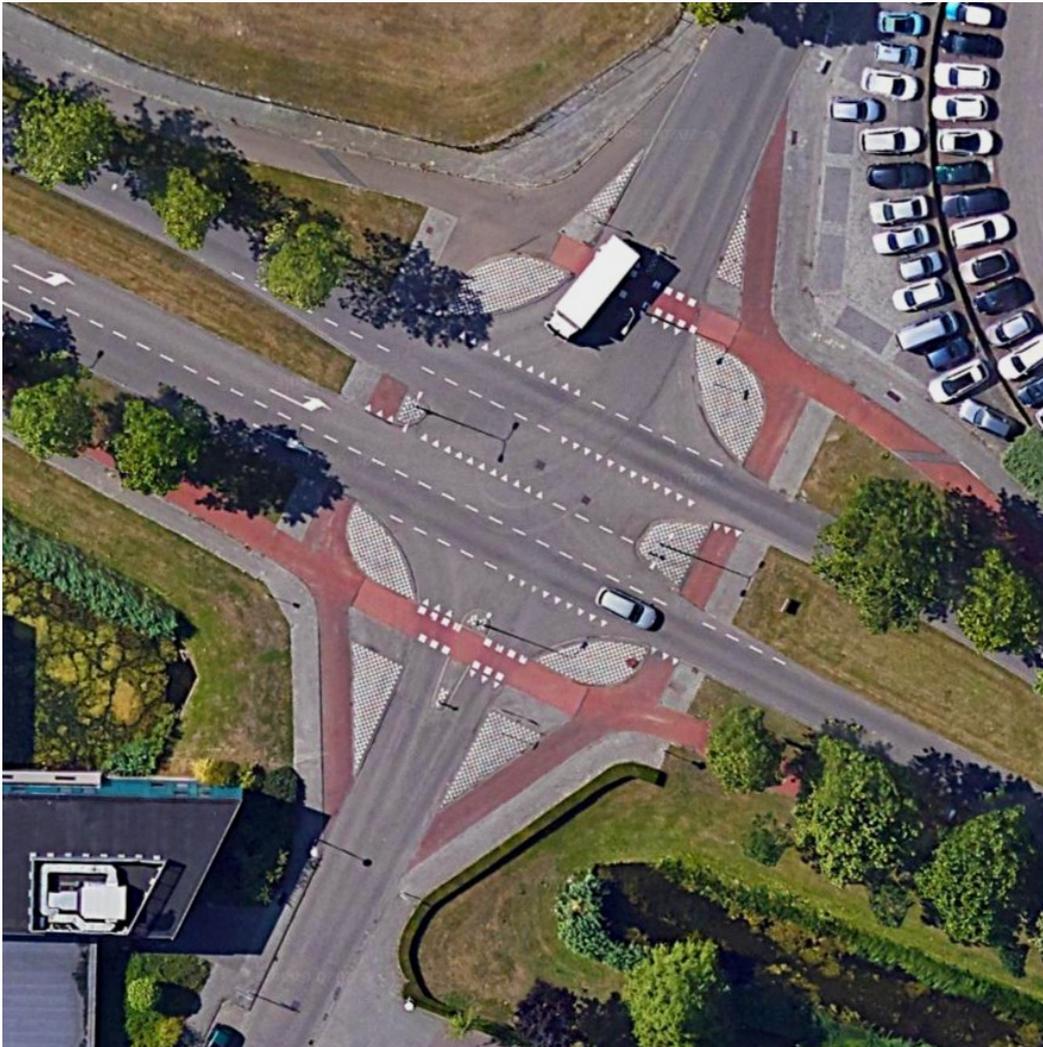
Führung des Radverkehrs an Straßenknoten mit dem Fußgängerverkehr (starre Schiene)
